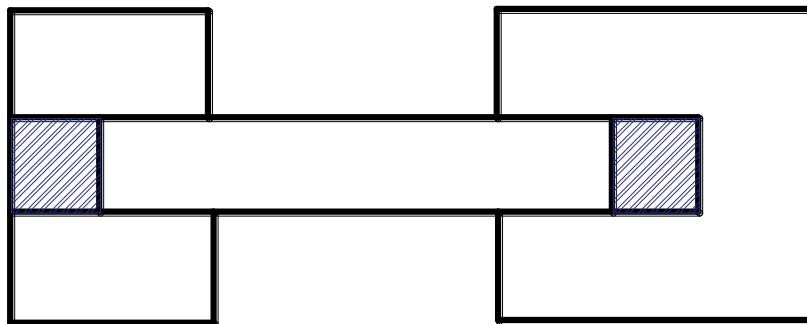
VISTA EN PLANTA DE ZAPATAS CONECTADAS.
